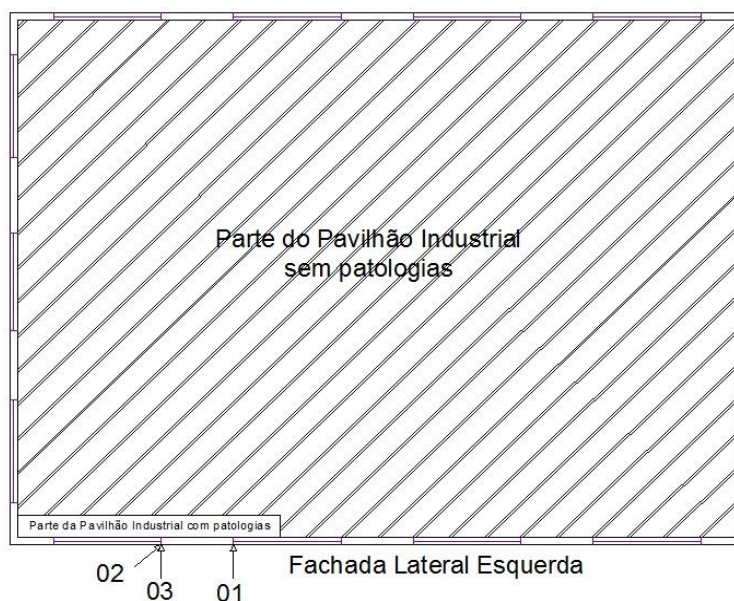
Croqui das patologias no Pavilhão Industrial
